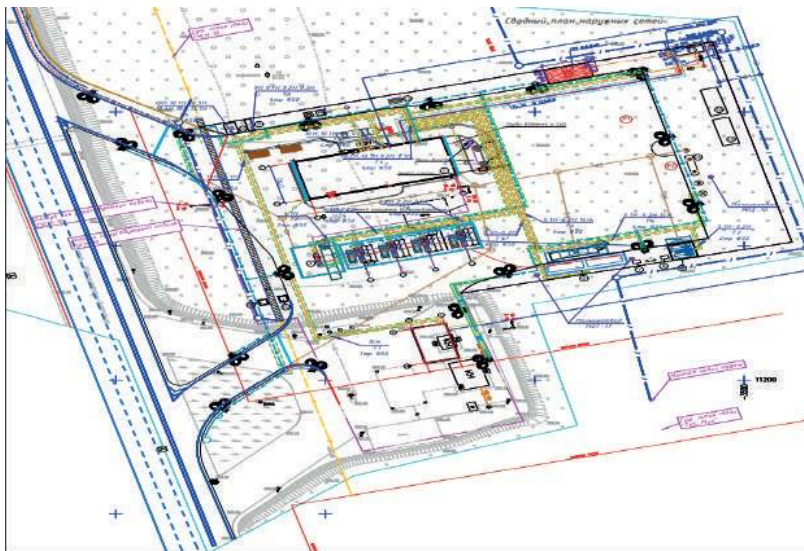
Сводный план наружных сетей при строительстве АЗС
